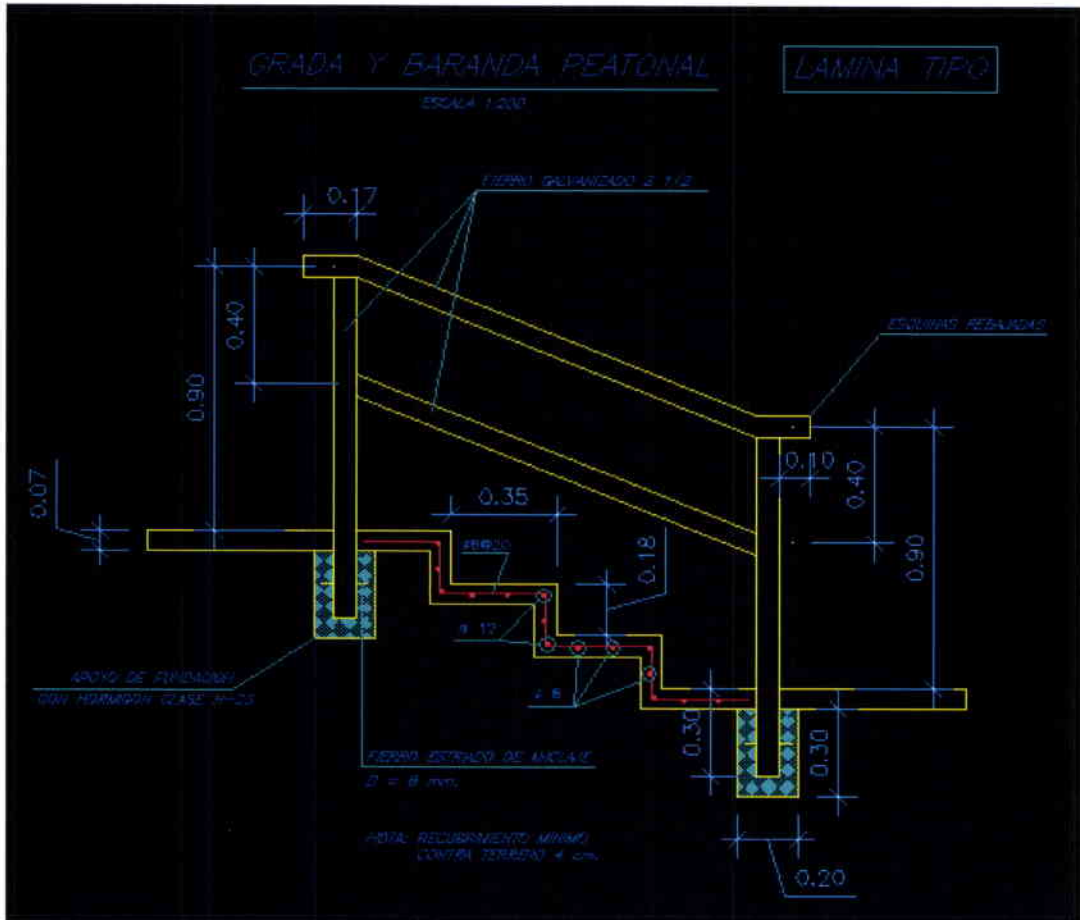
Sistema de anclaje según plano de licitación.
